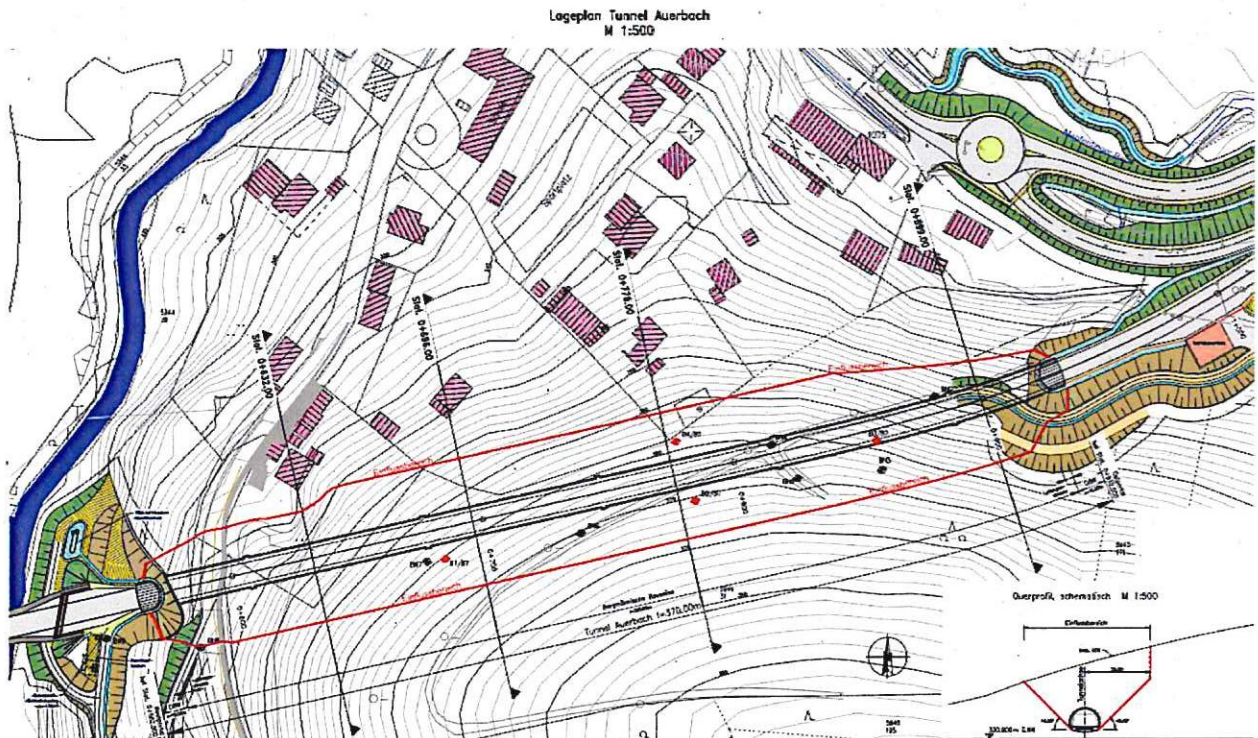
Skizze Lageplan „Tunnel Auerbach“ (Tektur)
